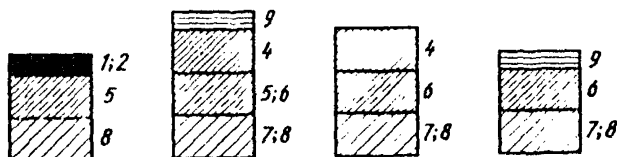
Рекомендуемые конструкции дорожных одежд со слоями из укрепленных грунтов для дорог I и II (а); III (б); 1У и У (в) категорий: 1 и 2 – одно- и двухслойное асфальтобетонное покрытие; 3 – цементобетонное покрытие; 4 – черный щебень; 5 – основание из цементогрунта I класса прочности; 6 – основание из грунта, укрепленного карбамидоформальдегидной смолой или комплексными методами, I класса прочности и повышенной деформативности; 7 – основание из грунтов, укрепленных цементом, карбамидоформальдегидной смолой и комплексными методами, II класса прочности; 8 – морозозащитный слой из укрепленного грунта II–III классов прочности; 9 – двойная поверхностная обработка
